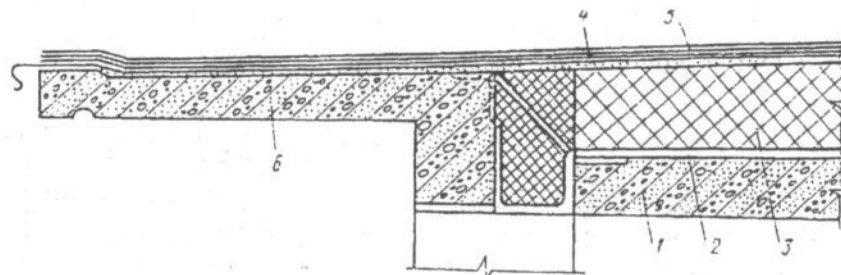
Конструкция бесчердачной неветилируемой совмещенной крыши
